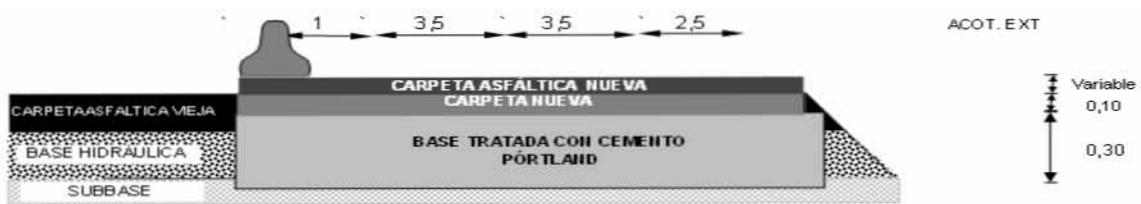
Segunda alternativa de pavimento flexible. La mejor opción para controlar los asentamientos
